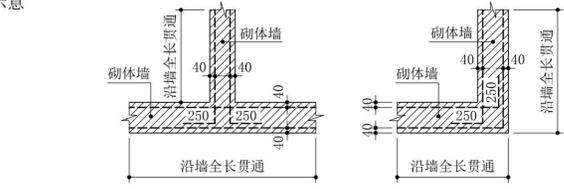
砌体墙与混凝土边框交接处拉结筋做法示意
